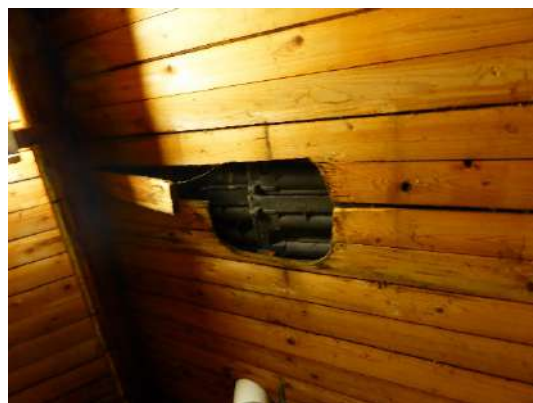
Foto project houten dak beschouwd geen asbest waargenomen
